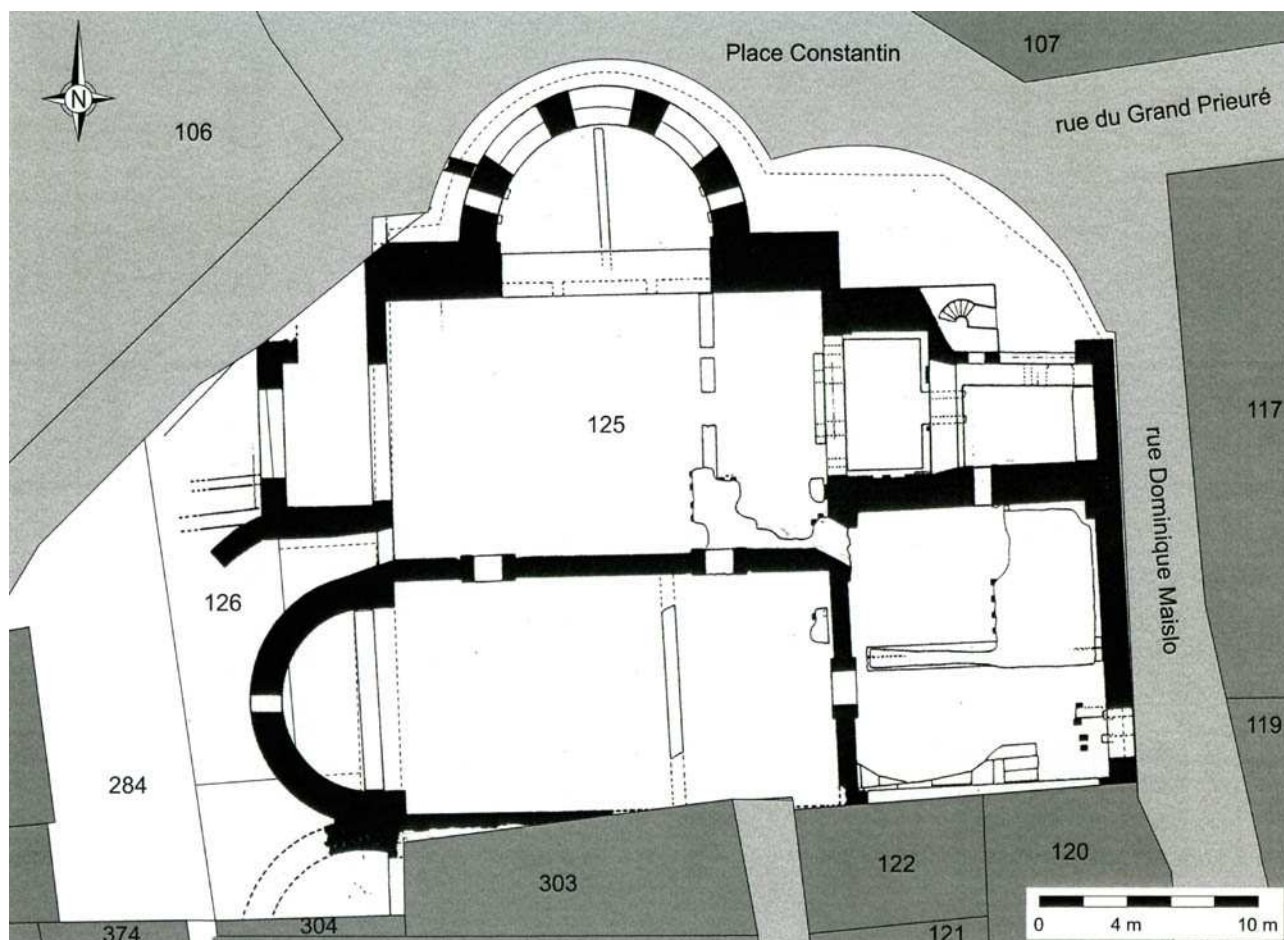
Plan général des thermes sur le fond cadastral (DAO X. Chadeaux d'après M. Heijmans 2004, 145)
